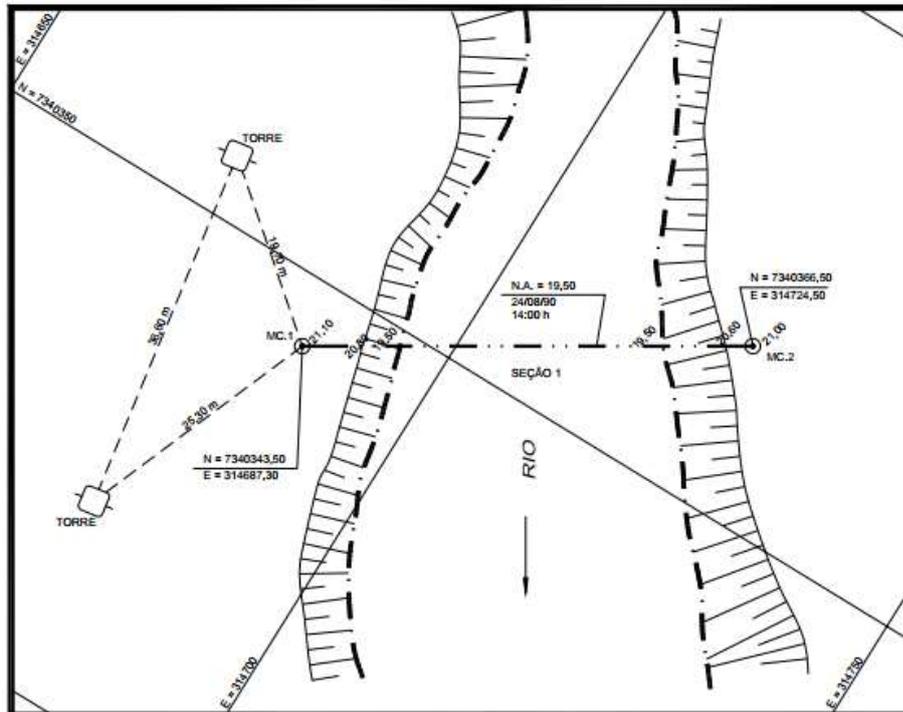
Exemplo de planta topográfica, contendo as seções batimétricas levantadas
